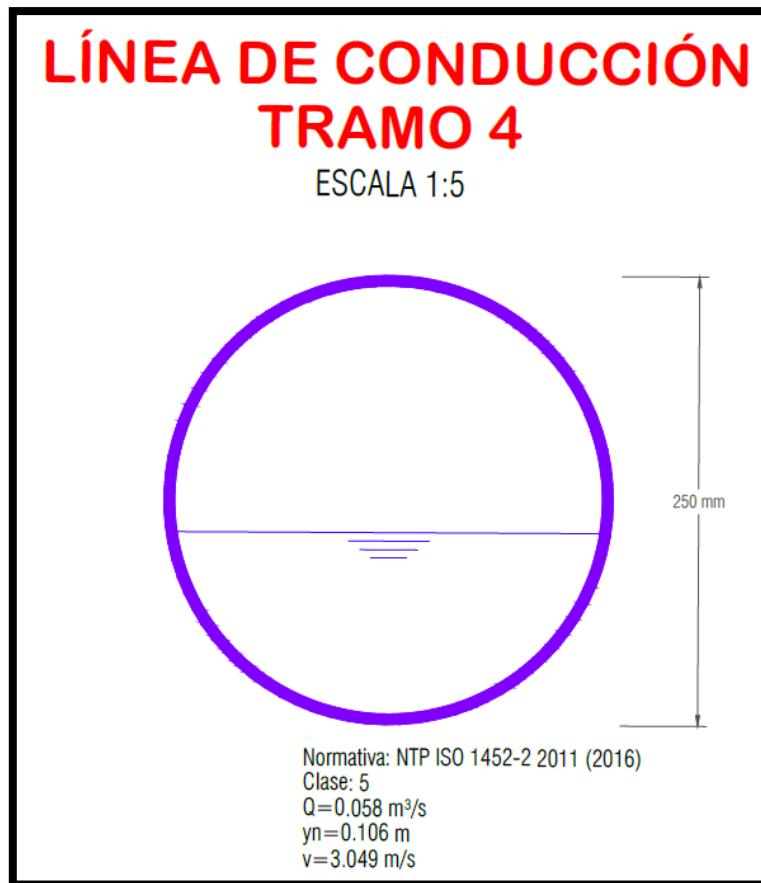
Sección típica de la tubería de PVC-U 250 mm, Tramo 4
